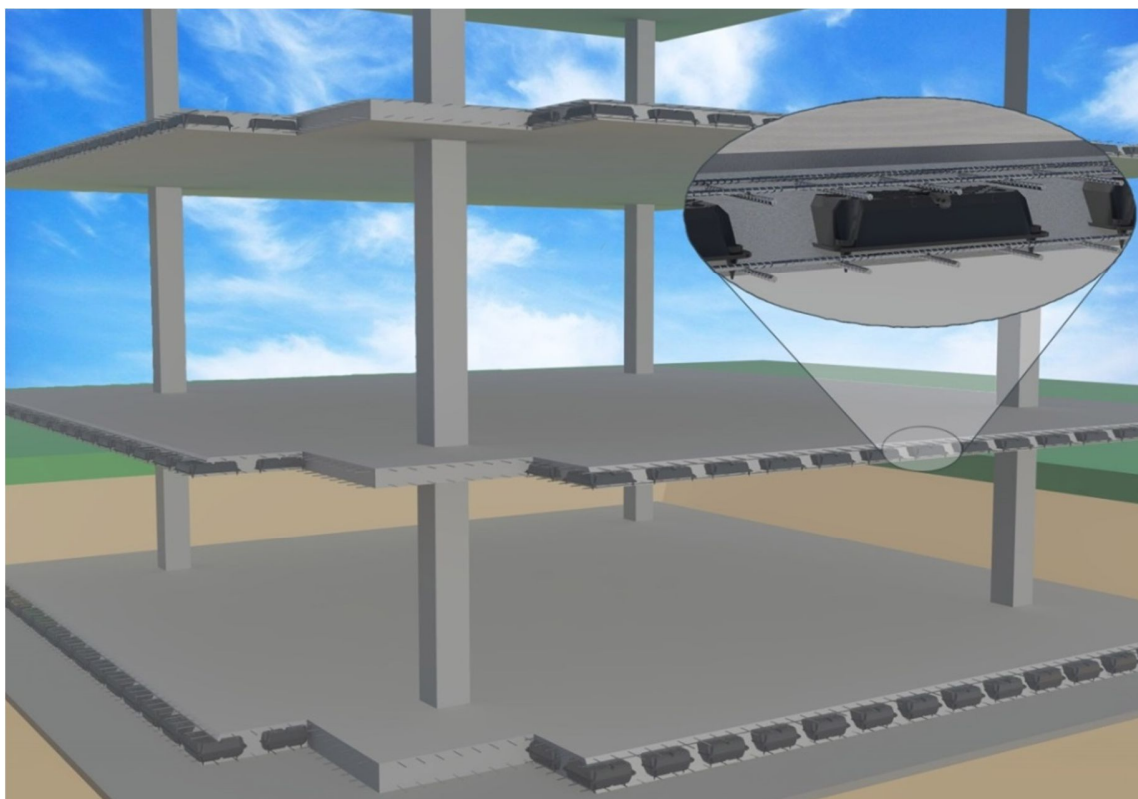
Общий вид установленной несъемной опалубки в каркасе здания (в перекрытиях и фундаментной плите)
